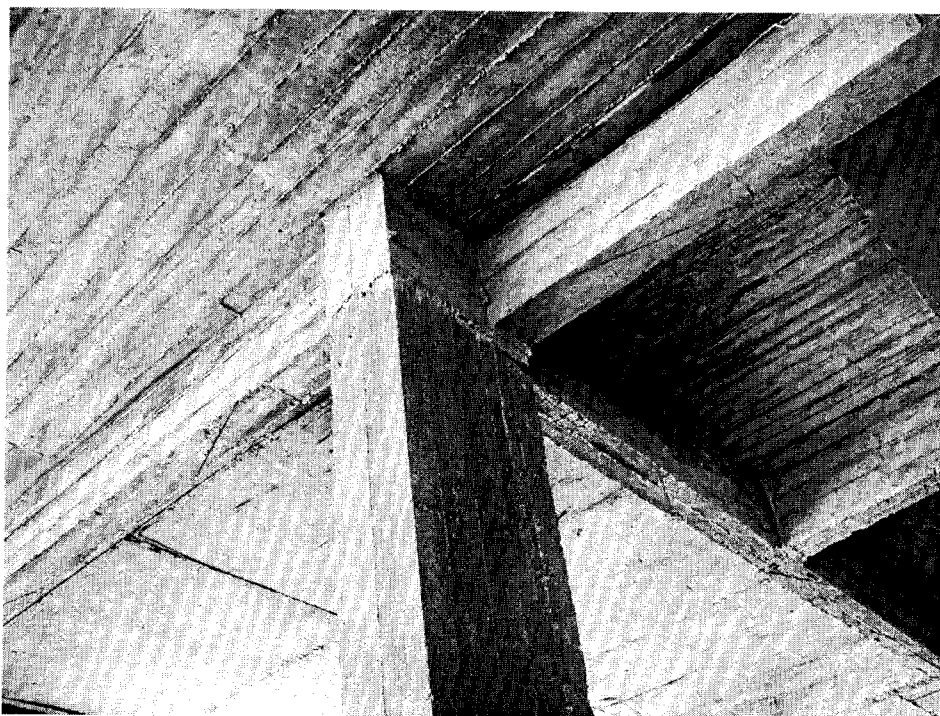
Vigas excéntricas llegando a una columna y deficiencias de configuración.
